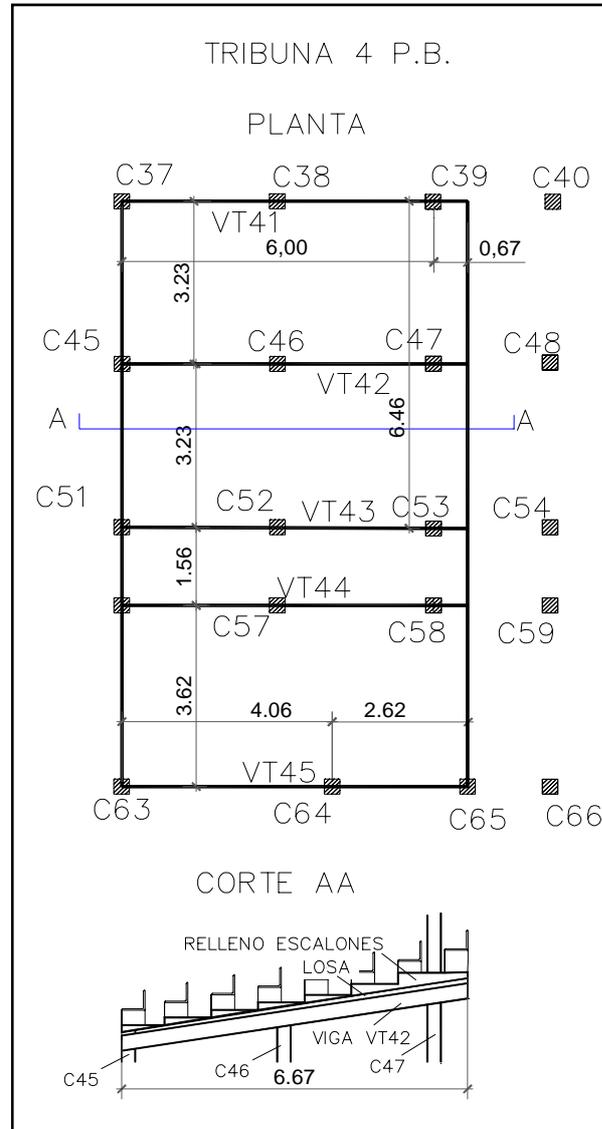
Esquema de tribuna n° 4 en planta baja.
